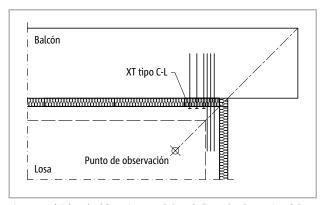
Schöck Isokorb® XT tipo C: Balcón voladizo sobre la esquina del edificio (utilización de XT tipo C-L)
